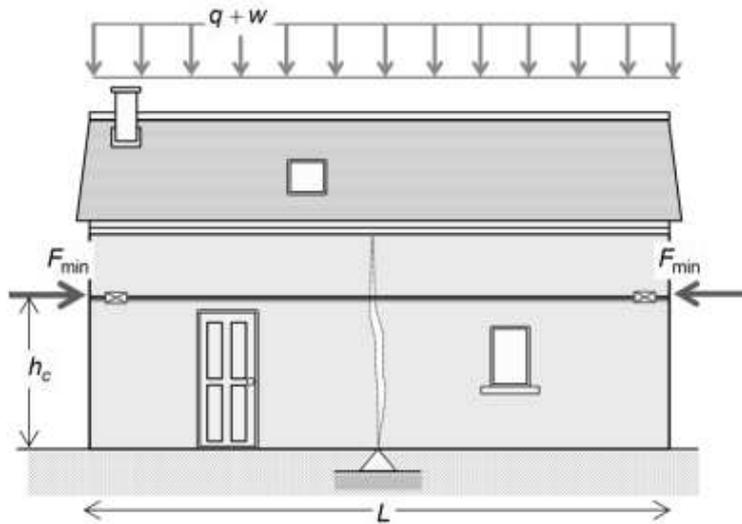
schéma de calcul de la force minimale permettant la stabilité
